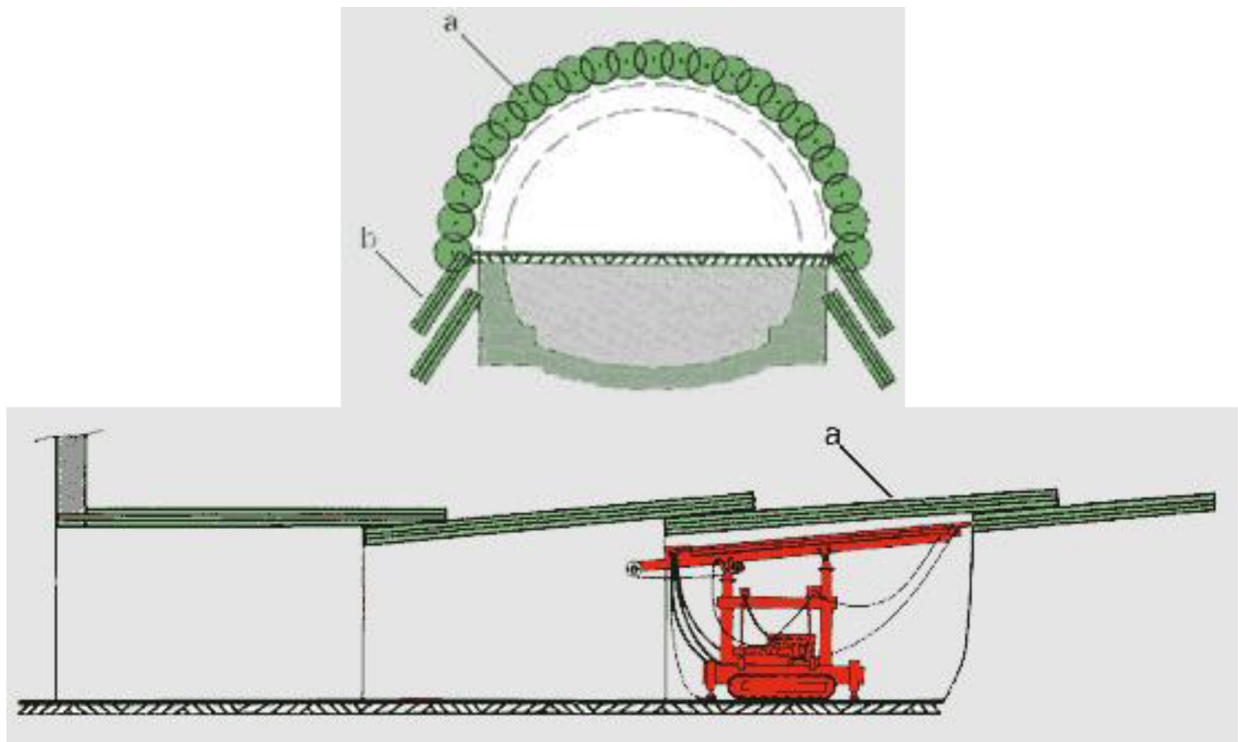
Будівництво тунелю із захисним навісом над вибоєм із повздовжніх (а) і підпірних (b) циліндрів, утворених струменевою цементациєю ґрунту [9]
